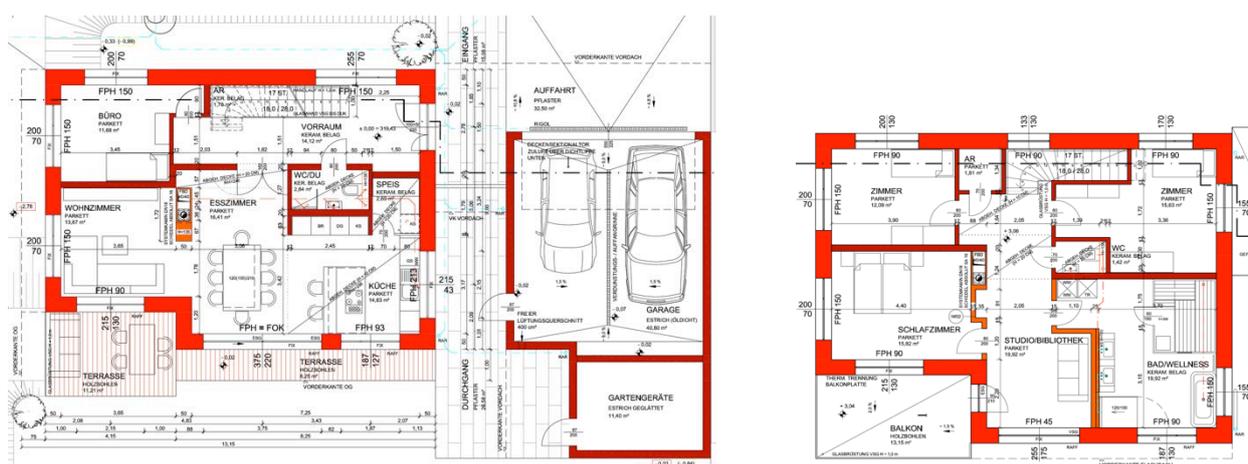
Grundrisse Erdgeschoß (links) und Obergeschoß von Haus K (@privat).
